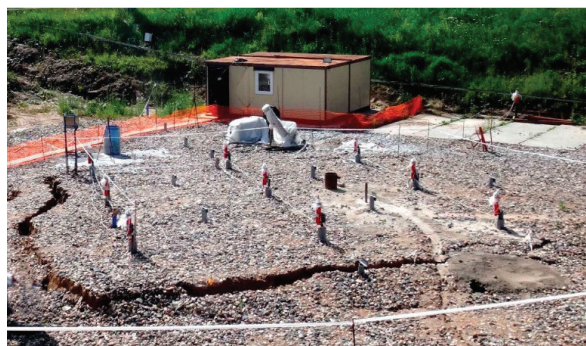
Проведение работ по подъему массива грунта над моделью фундаментной плиты на площадке опытного участка Загорской ГАЭС-2
